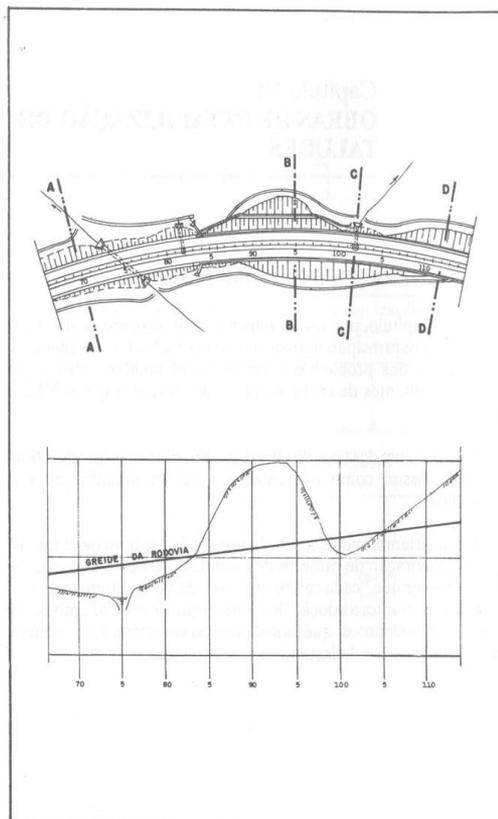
Planta e perfil longitudinal de uma rodovia
